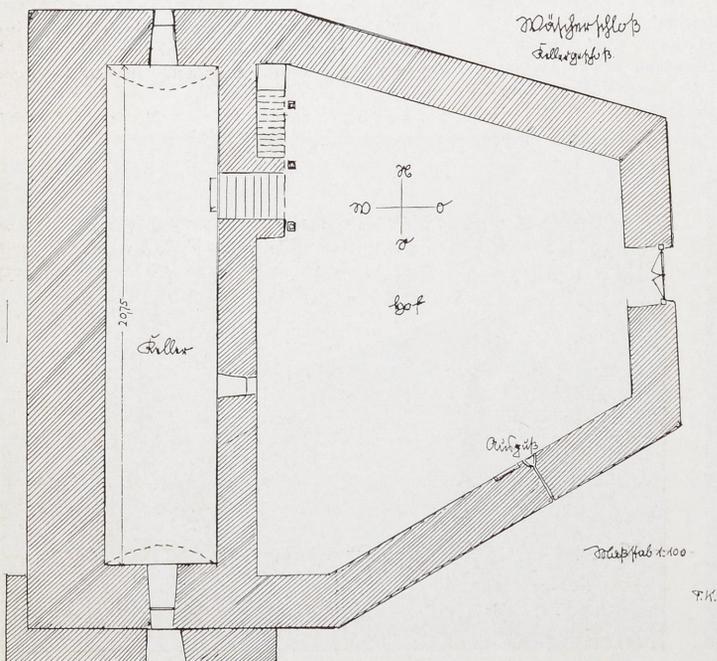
Wäscherschloß — Grundriß Kellergeschoß
